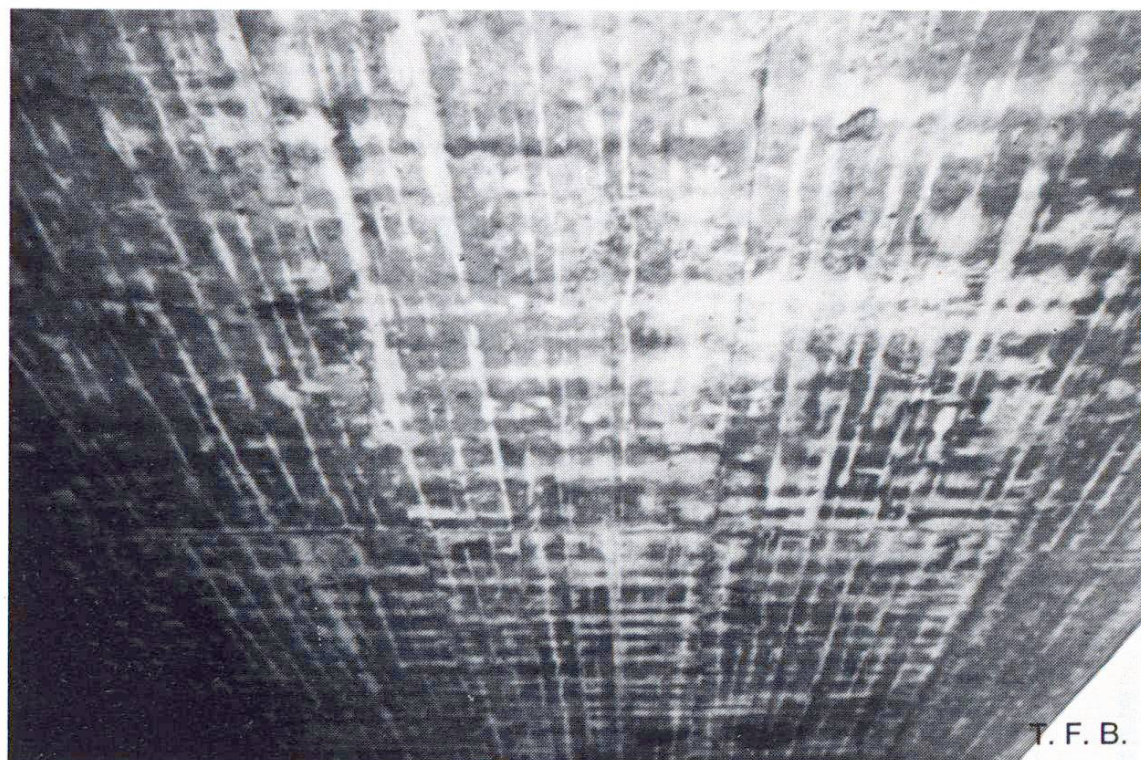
Dalle en béton dont l'armature est trop près de la surface inférieure. La ségrégation qui s'est produite sous les fers, dans le mortier et entre l'eau et le ciment a provoqué un sensible éclaircissement du béton.
